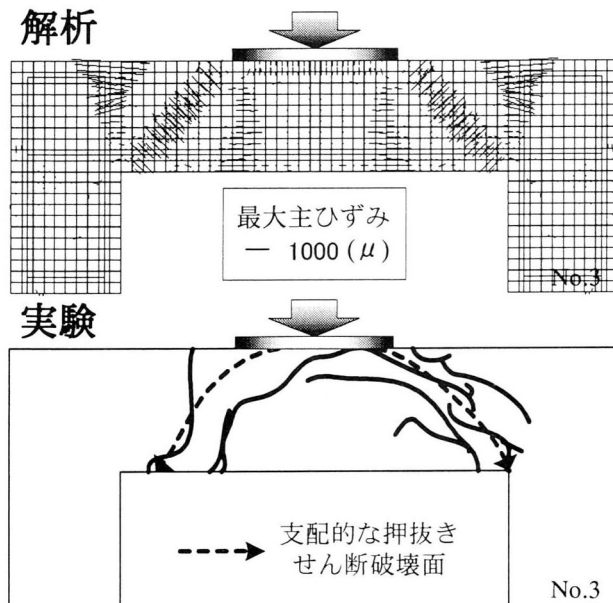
最大荷重時のひび割れ状況(No.3)
